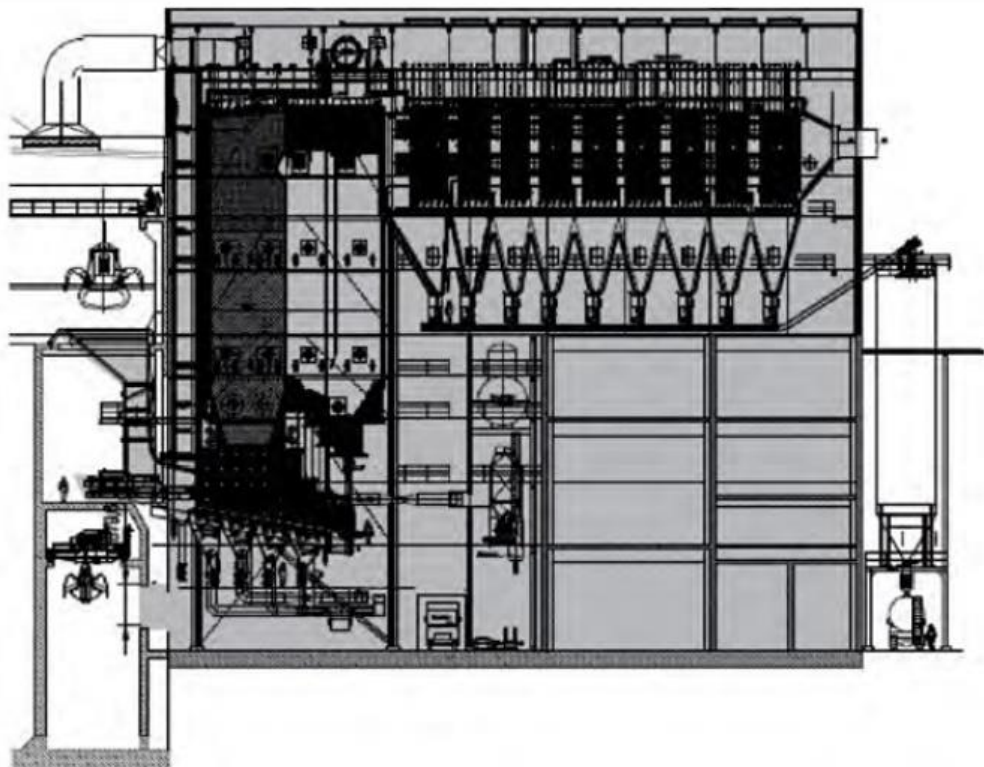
Contoh Ground Plan Waste Bunker (Weber)
